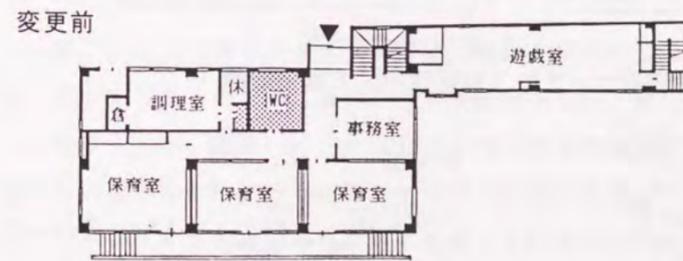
〈41〉港区西麻布福祉会館(旧保育所)1階平面図
